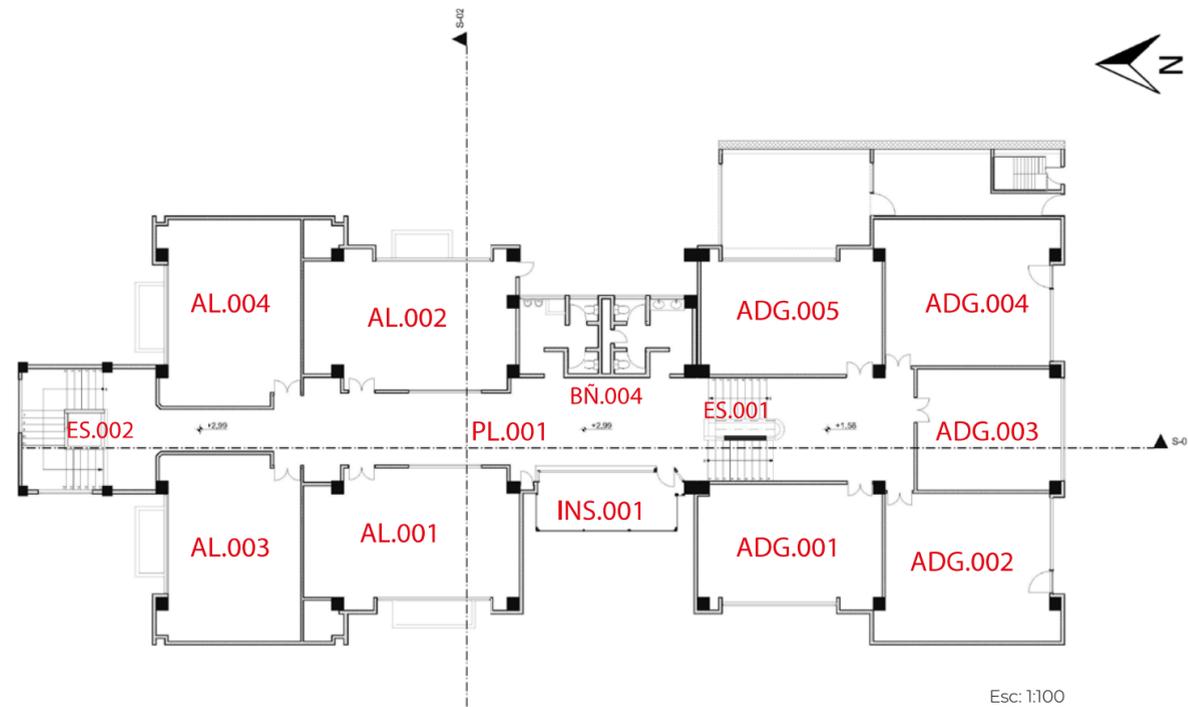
Codificación Primera y Segunda Planta Alta. Fuente: Elaboración propia
